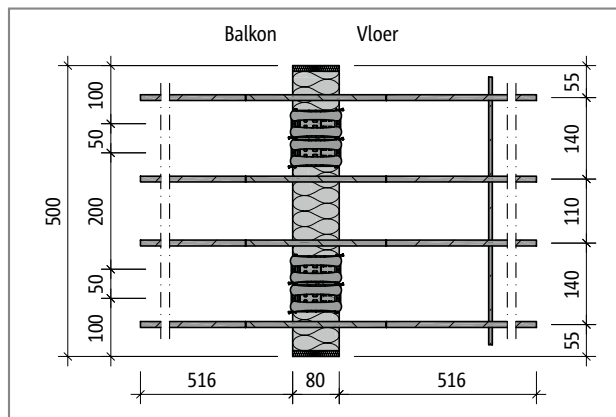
Schöck Isokorb® T type Q-E-V5: Bovenaanzicht
